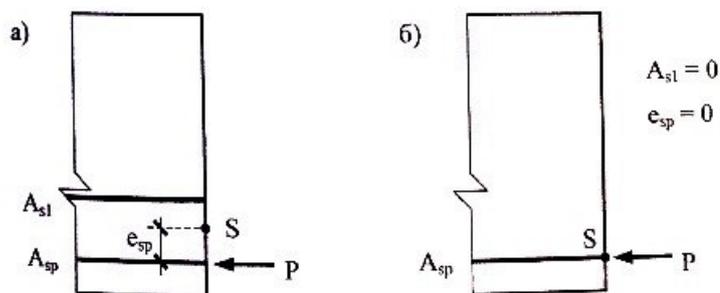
а) конструкция с двухрядным расположением арматуры по высоте; б) конструкция с однорядным расположением арматуры по высоте сечения
